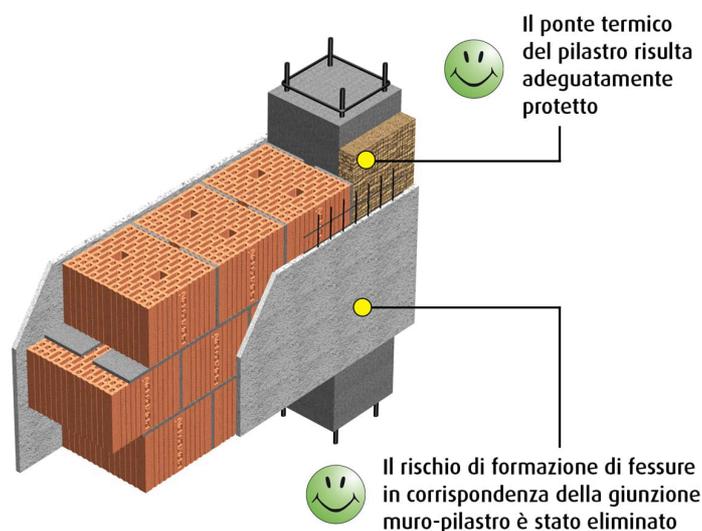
Collegamento tra muratura di tamponatura e telaio in c.a.: soluzione corretta con riduzione del ponte termico del pilastro.
